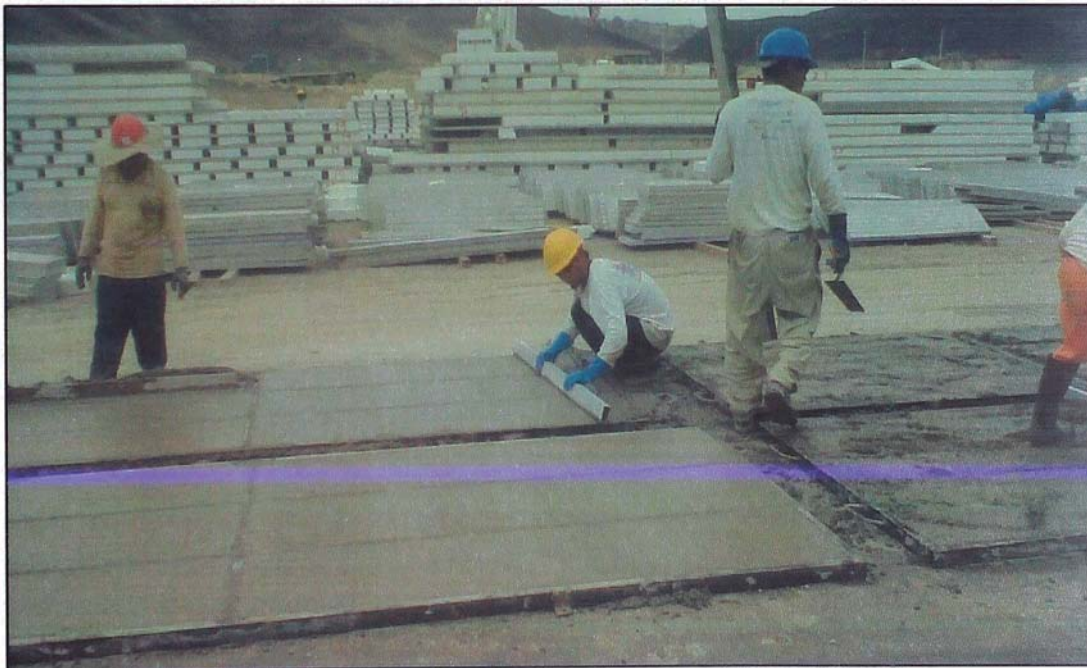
Fabricación de paneles – Perfilado de paneles
